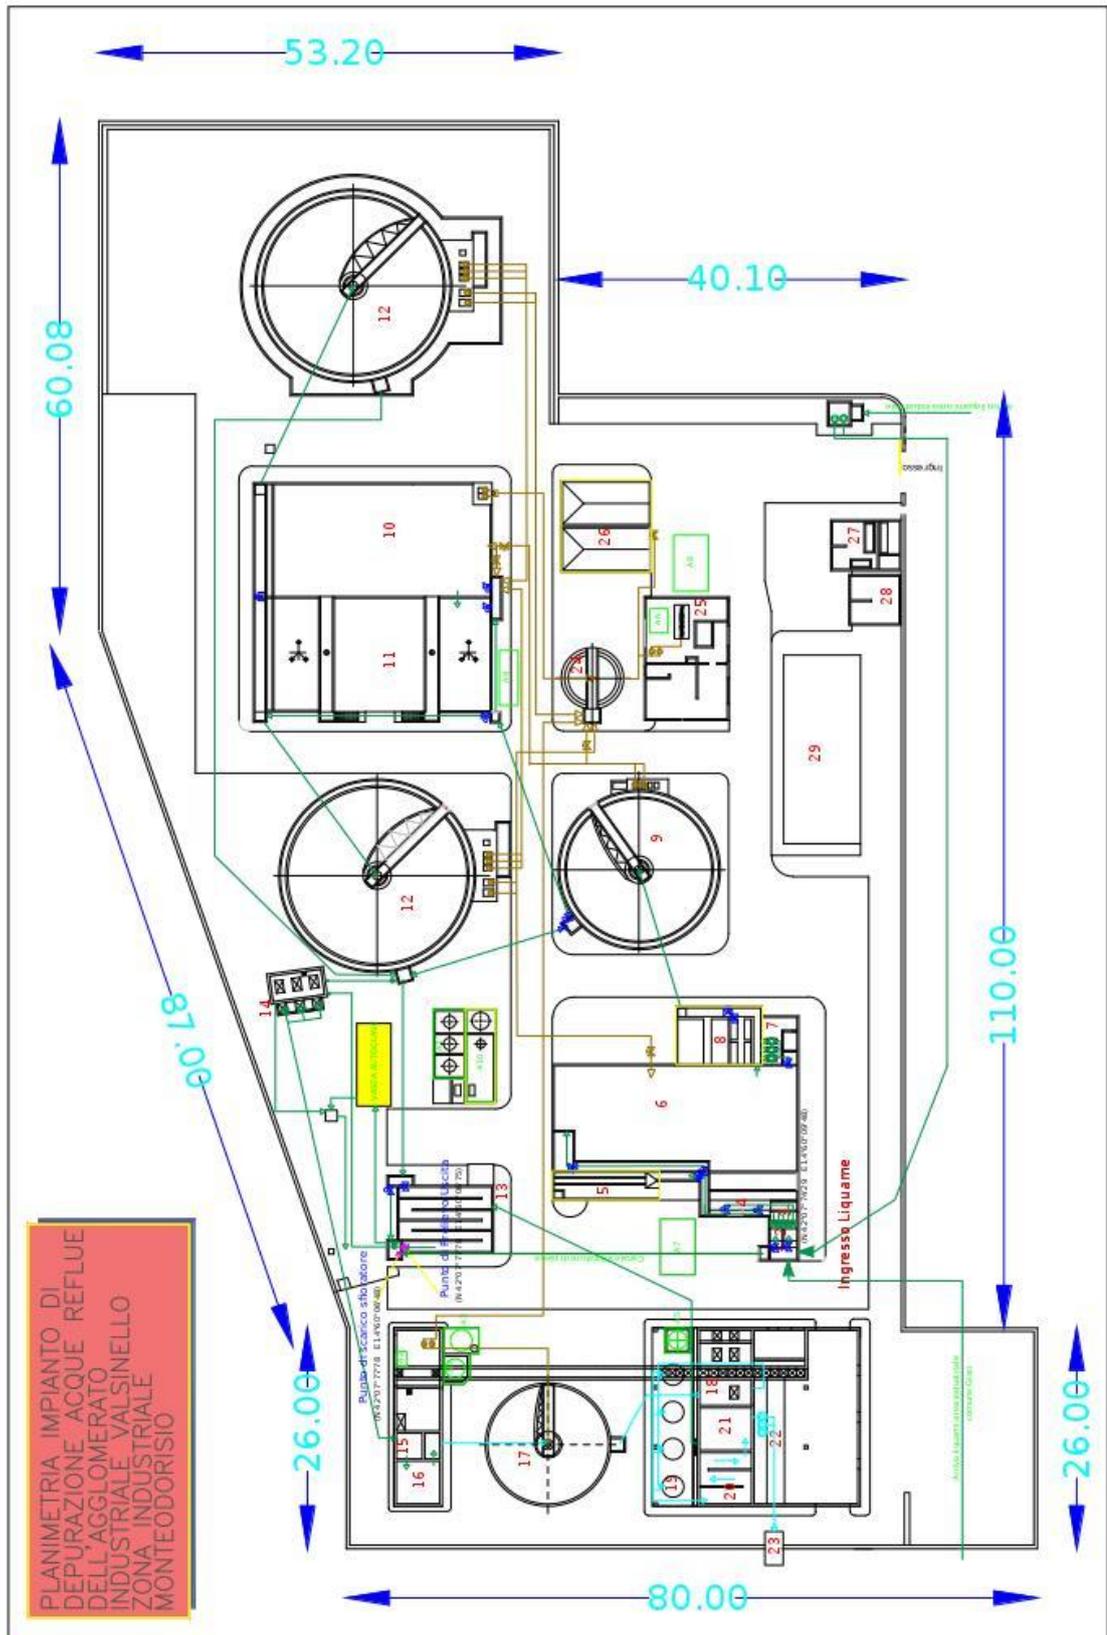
Planimetria dell'impianto di depurazione di Gissi - Val Sinello
